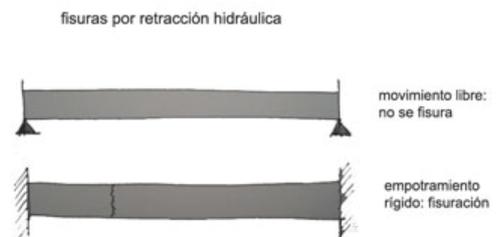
Fisuras por retracción hidráulica en elementos restringidos
